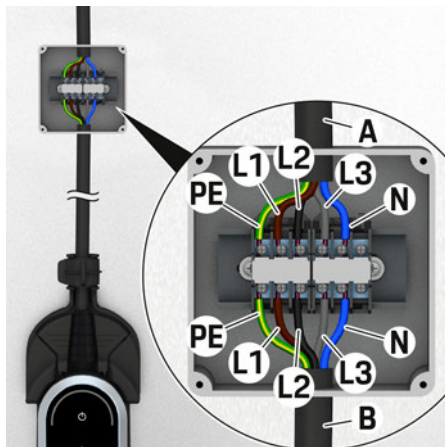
Collegamenti della presa di collegamento fisso (trifase)
